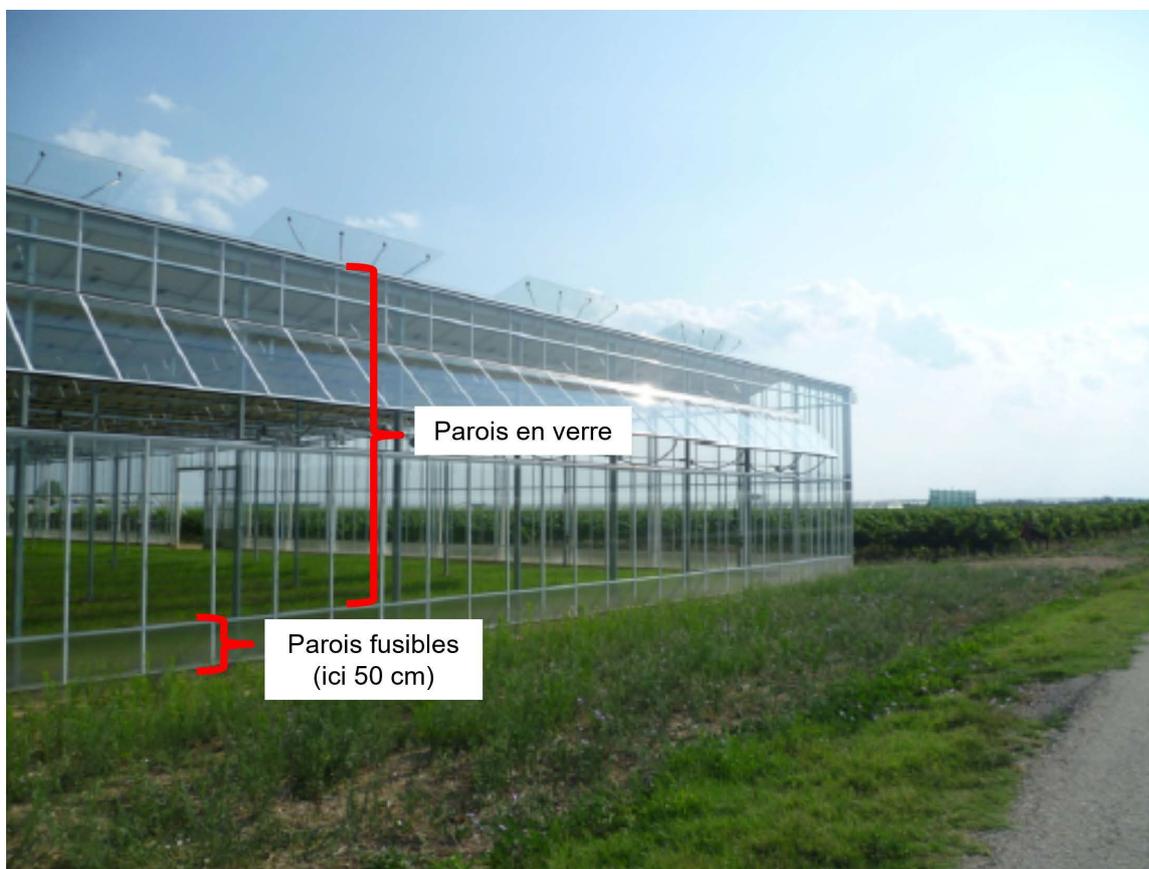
Face d'une serre équipée de parois fusibles (Source: REDEN)
